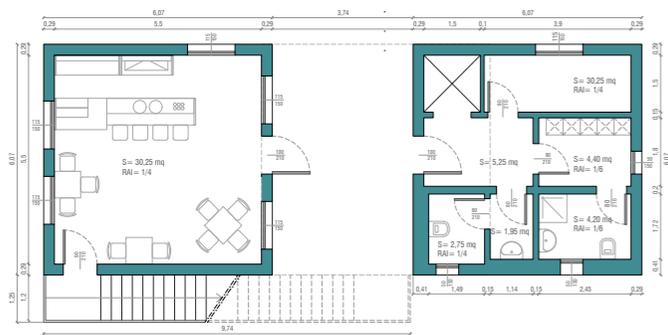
Pianta piano terra. Scala 1:200
